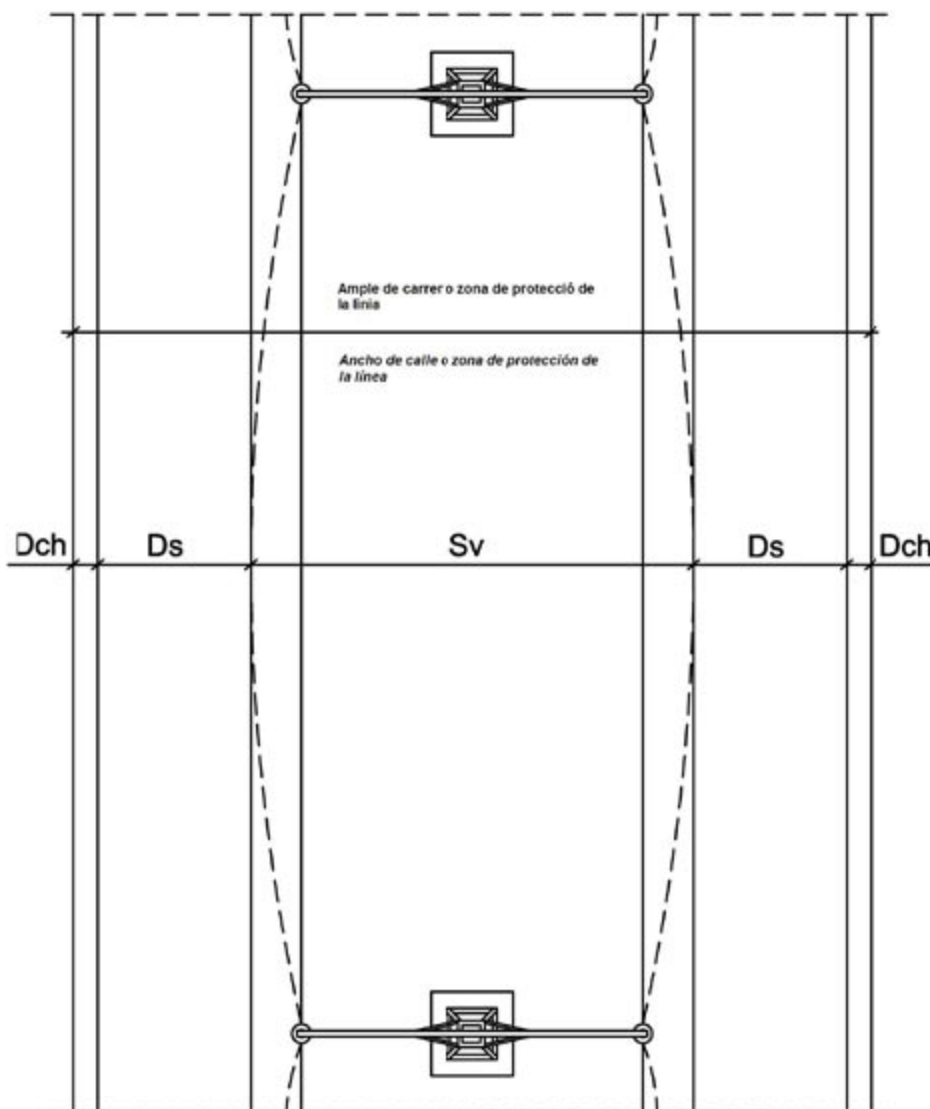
Planta tipo de la calle o zona de protección de la línea
